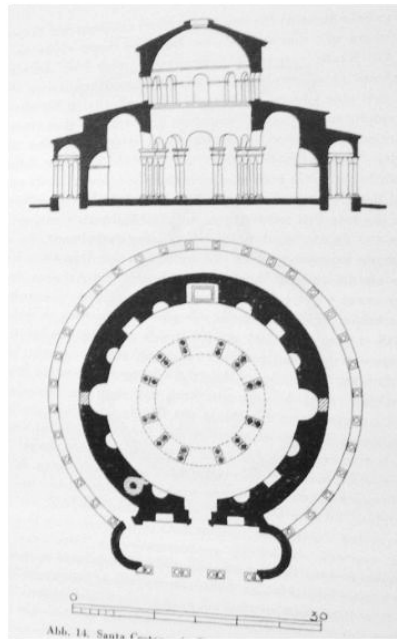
Auf- und Grundriss, Sta. Constanza, Rom, erste Hälfte 4. Jh.
